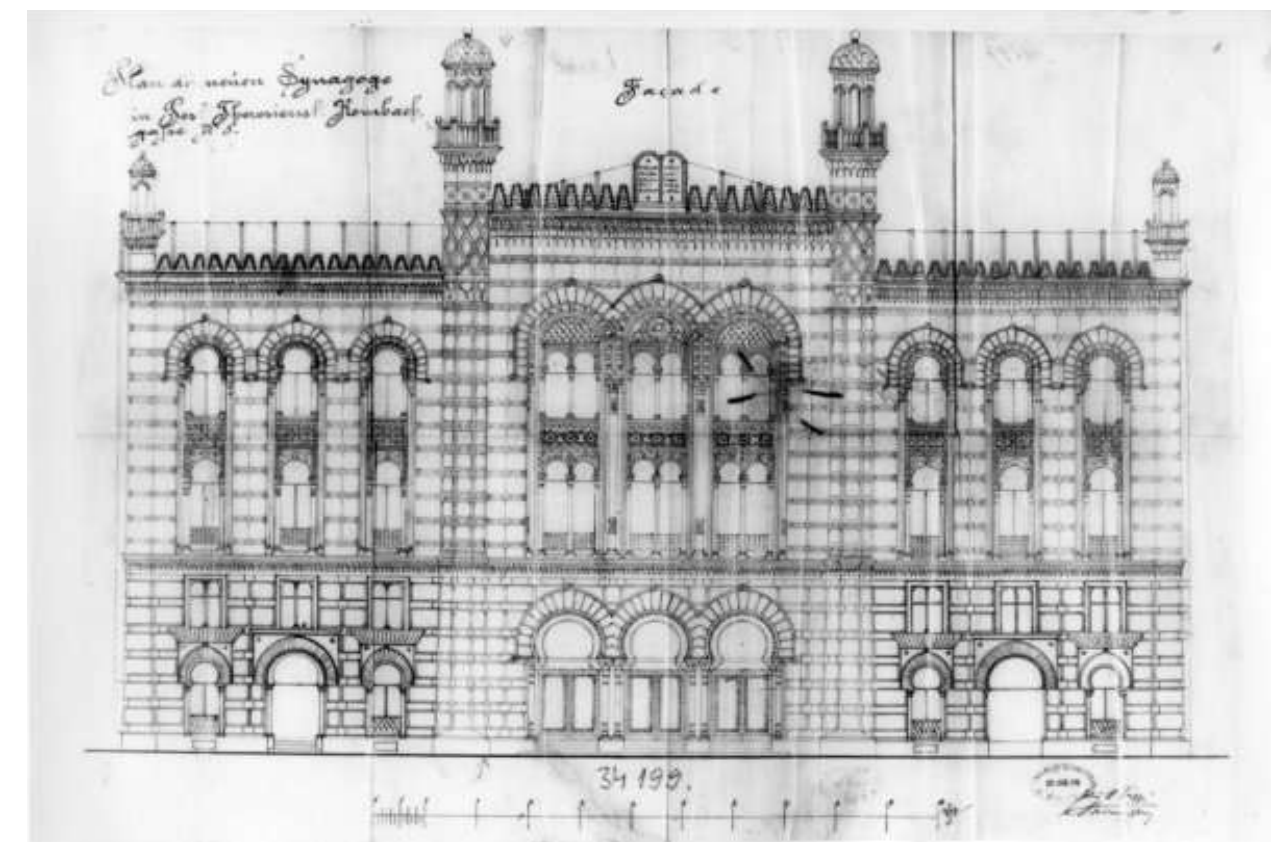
Westfassade Haupteingang Einreichplan Rumbach Synagoge
